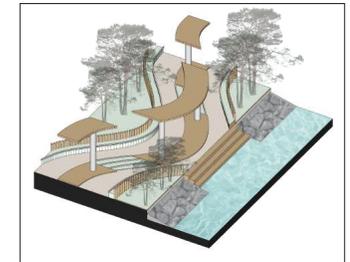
Planta y sección esquemáticas sobre la propuesta de intervención. Elaboración propia.
